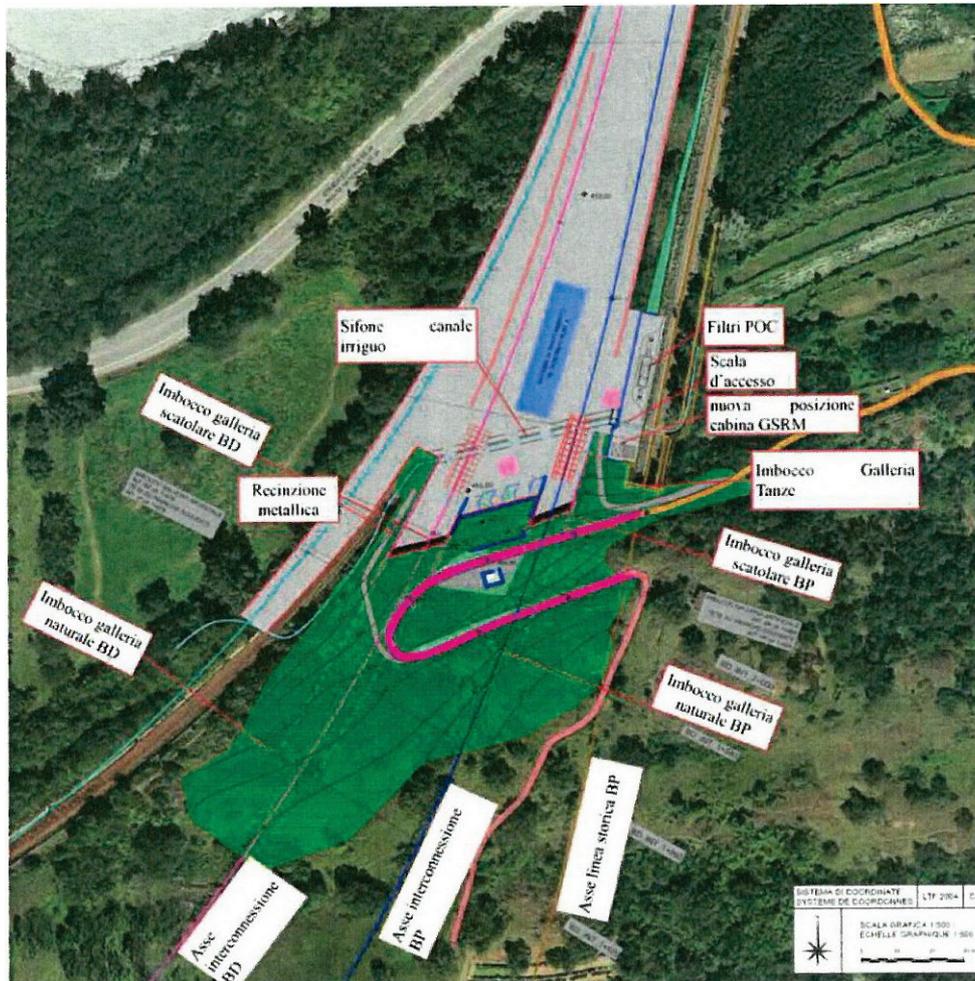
Planimetria Imbocco Est Tunnel di Interconnessione
